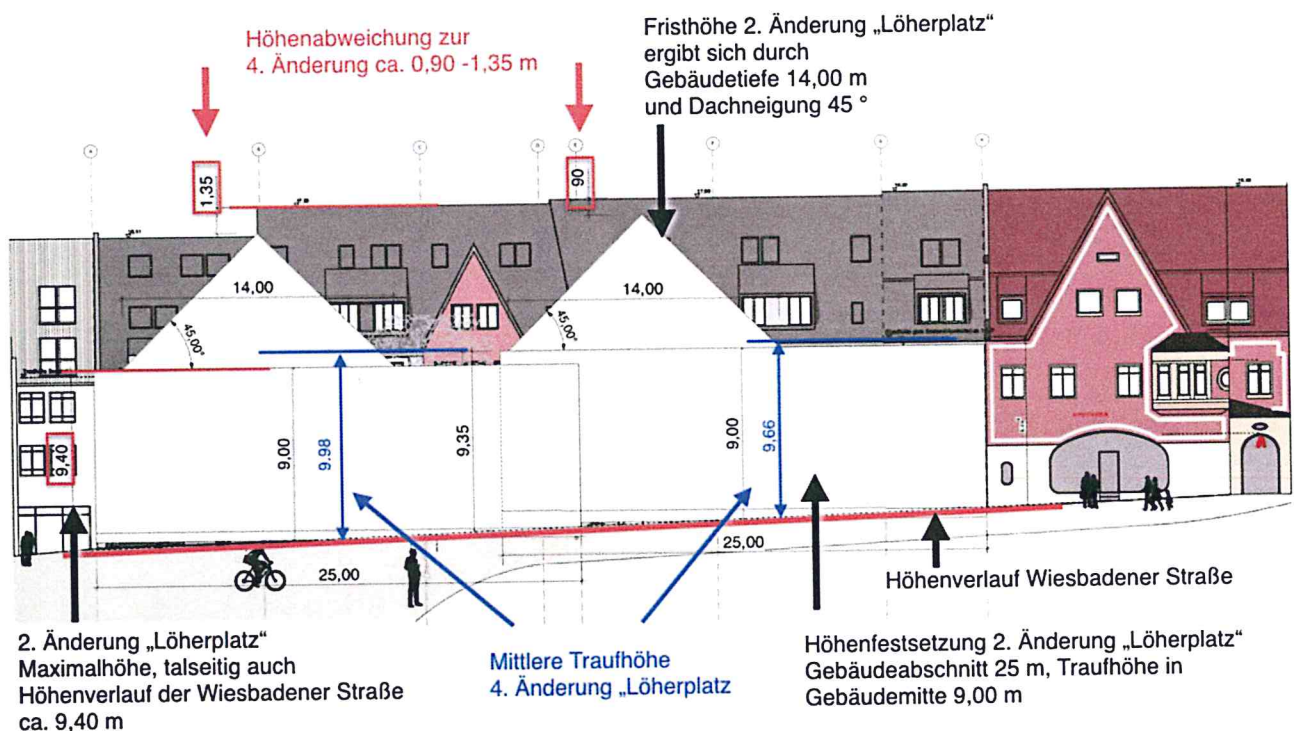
„Vergleich - Fassadendimension 2. Teiländerung (weiß), geplanten 4. Teiländerung (farbig)“
